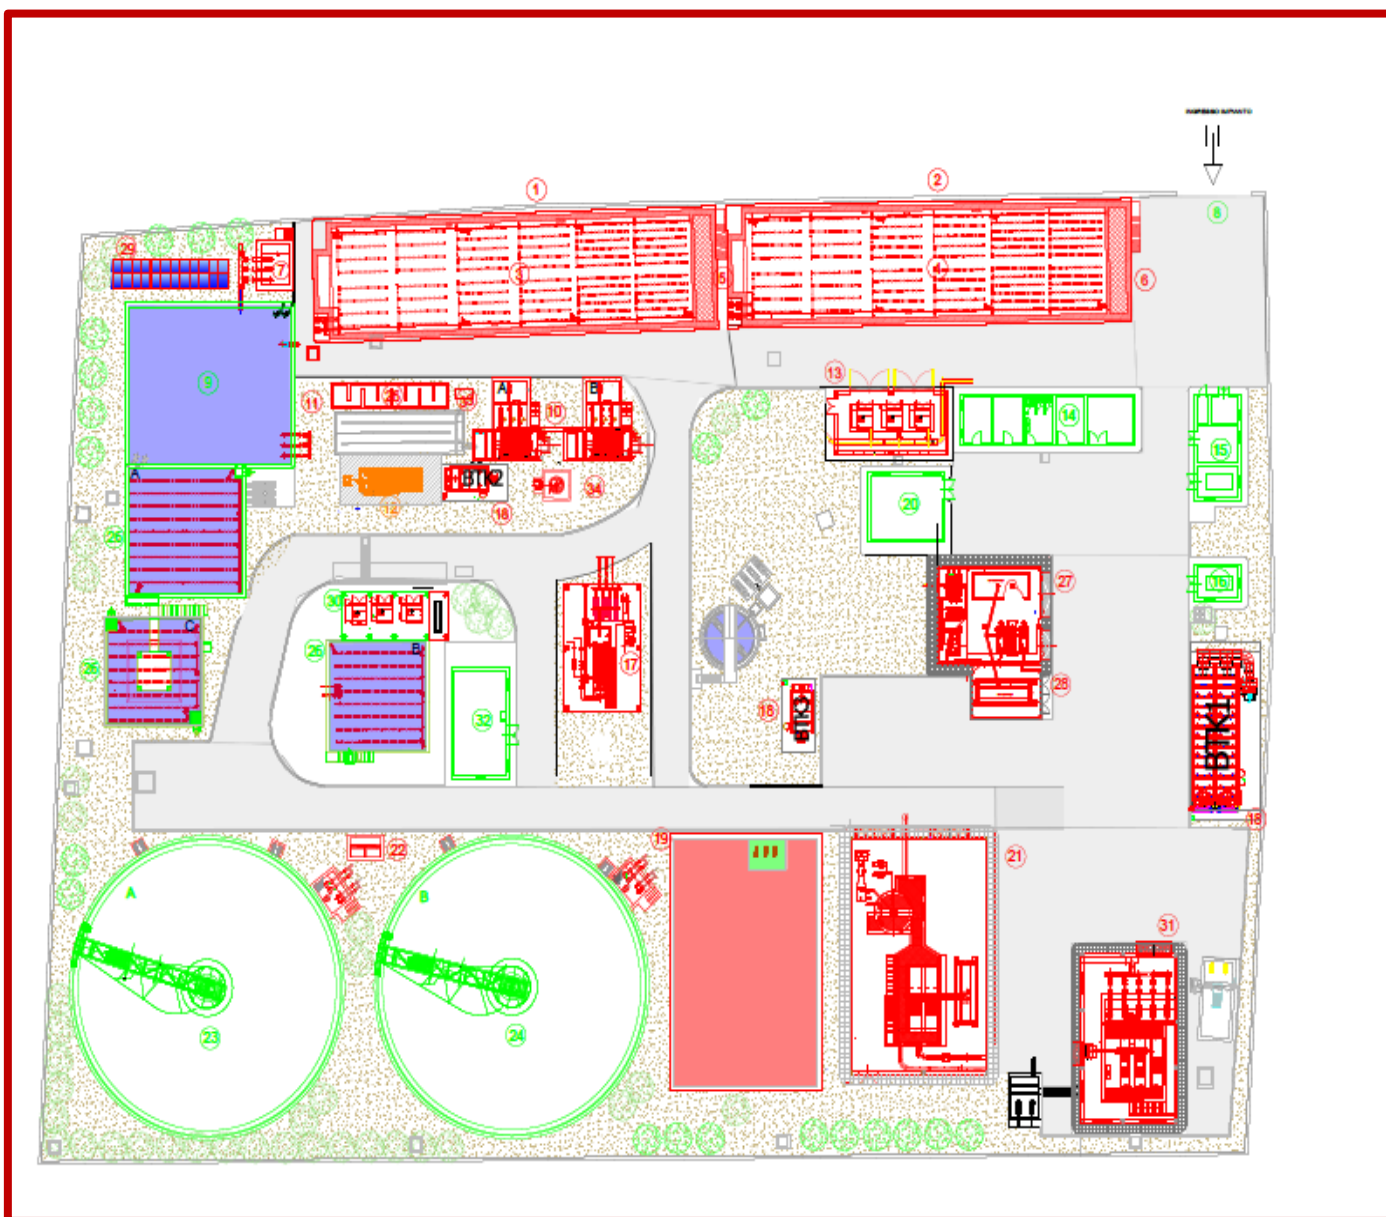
Planimetria dell'impianto nella configurazione di progetto
